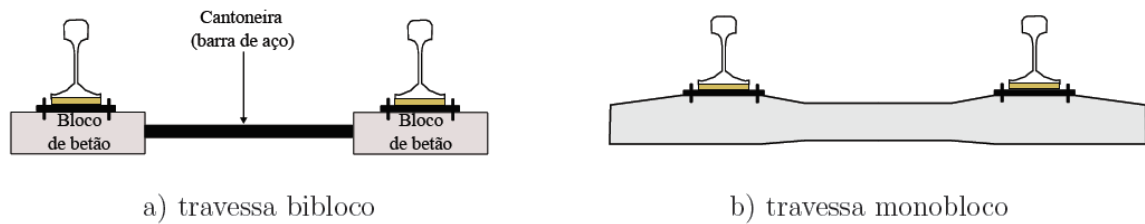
Tipos de travessas de betão [Vale, 2010]
